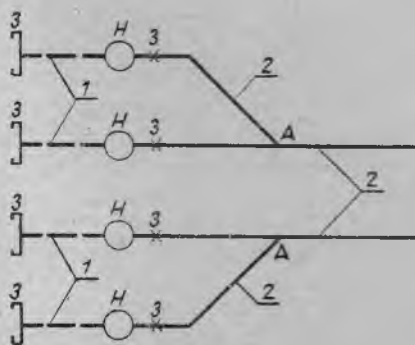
Схема соединения всасывающих и напорных трубопроводов:
